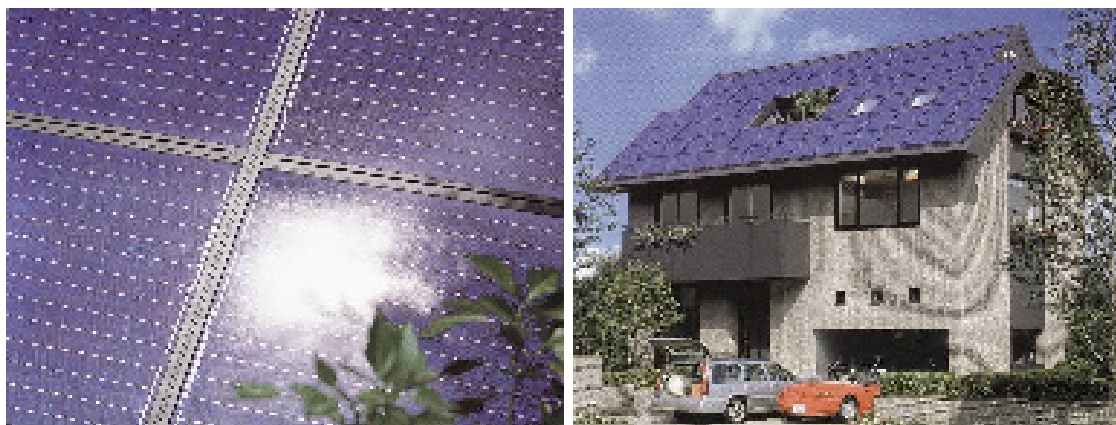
Photo d'une installation utilisant le système d'intégration en toiture Just Roof de MSK
